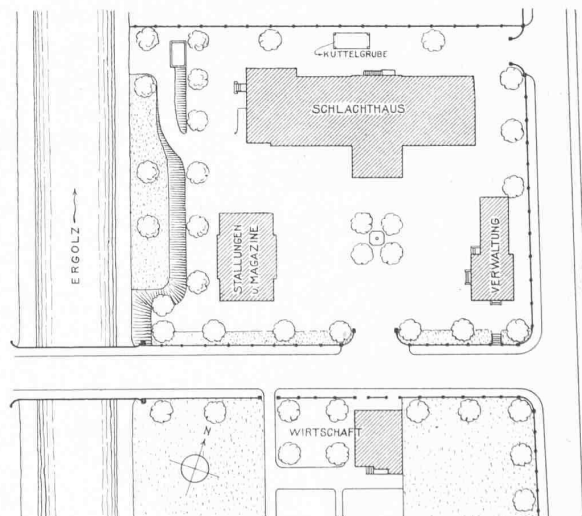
Lageplan der Schlachthof-Anlage. — Masstab 1 : 1500.
